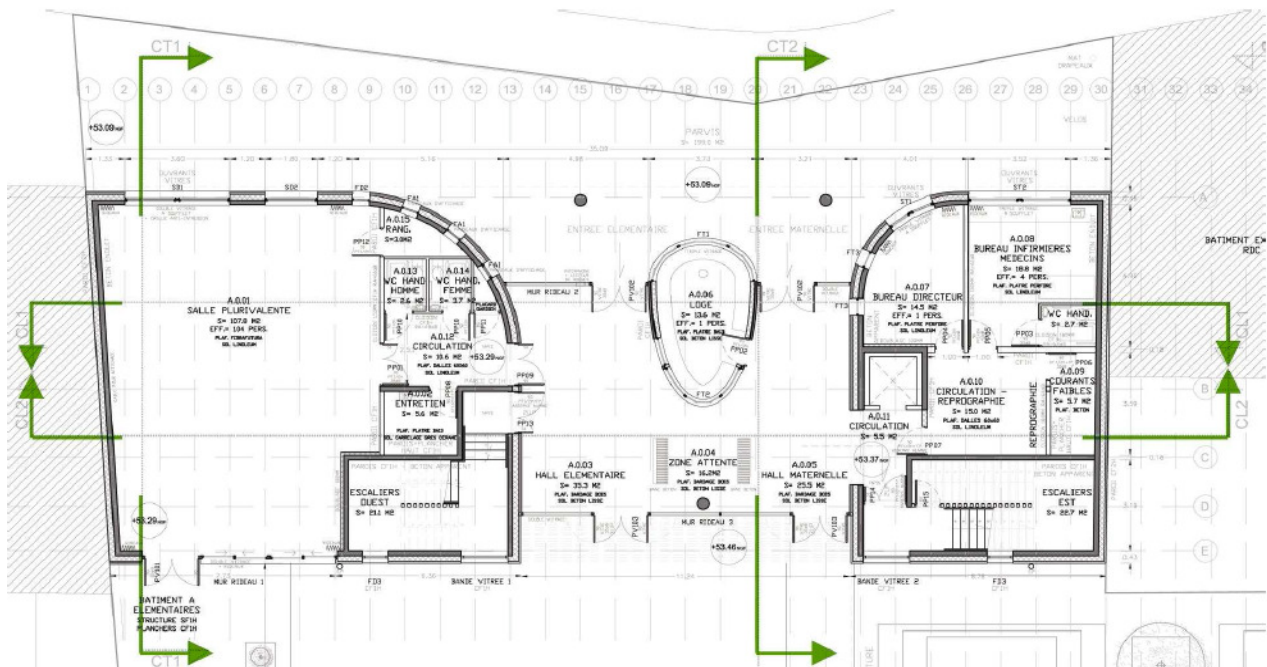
PLAN DU RDC DU BATIMENT A (HALL D'ACCUEIL ET SALLE PLURIVALENTE)
